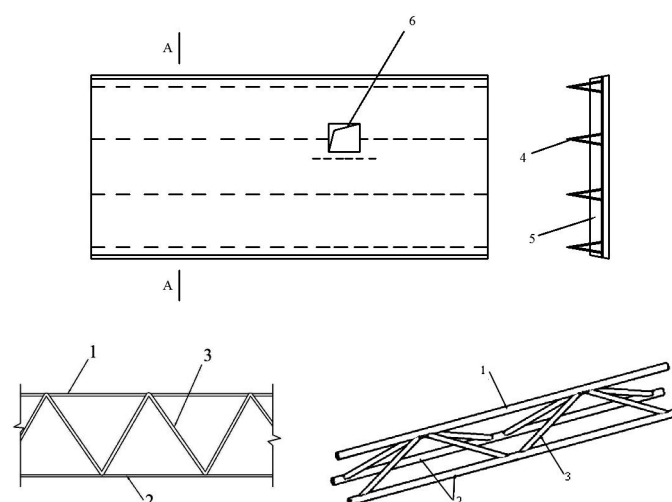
预制混凝土叠合楼板设置桁架钢筋构造
